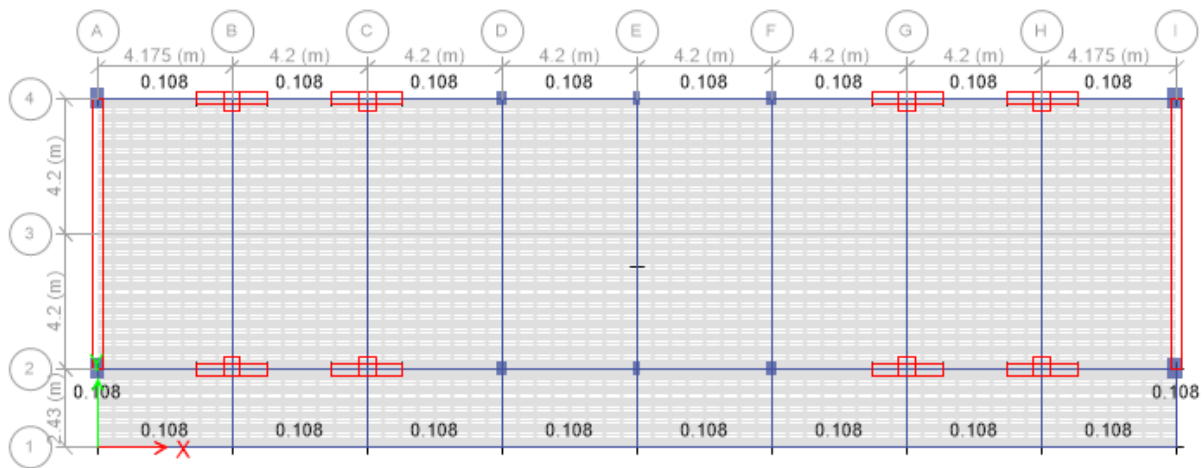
Vista general de las cargas vivas asignadas a las viguetas - Metrados de cargas de una viga
